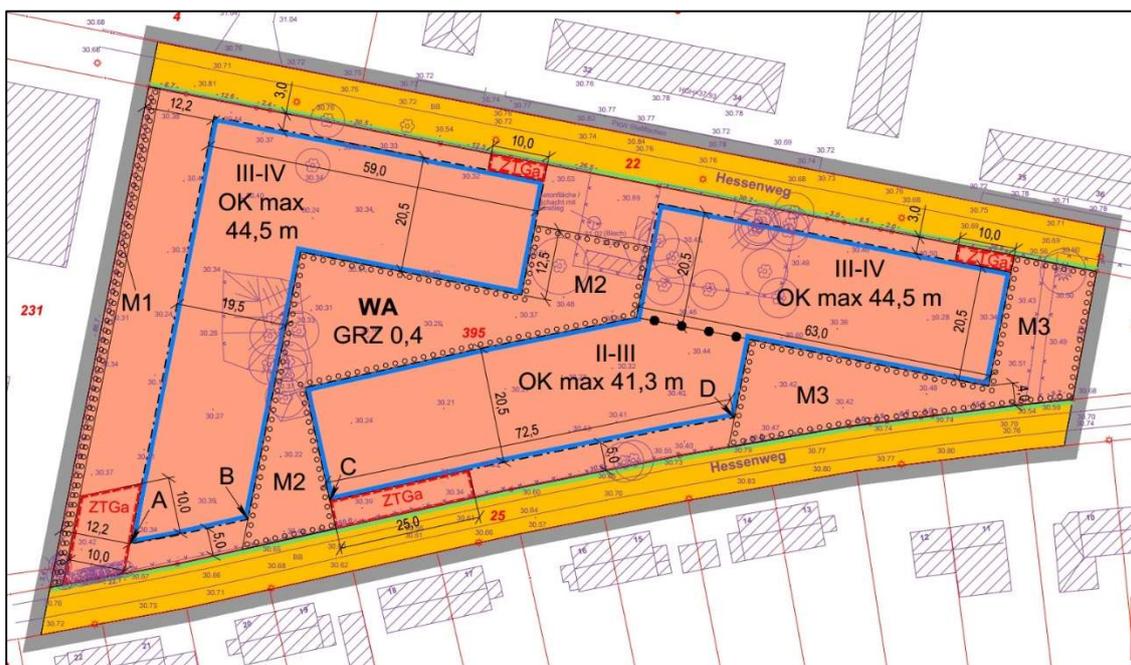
Ausschnitt aus der Planzeichnung des Bebauungsplans (Stand Juni 2024)
